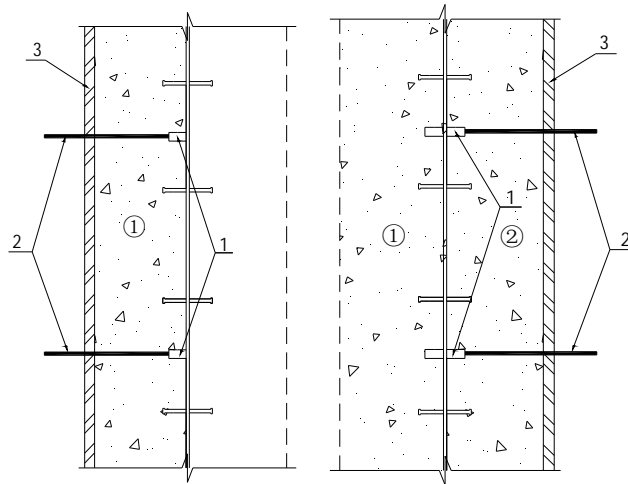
单层钢板混凝土剪力墙分侧浇筑示意（浇筑顺序①→②）
